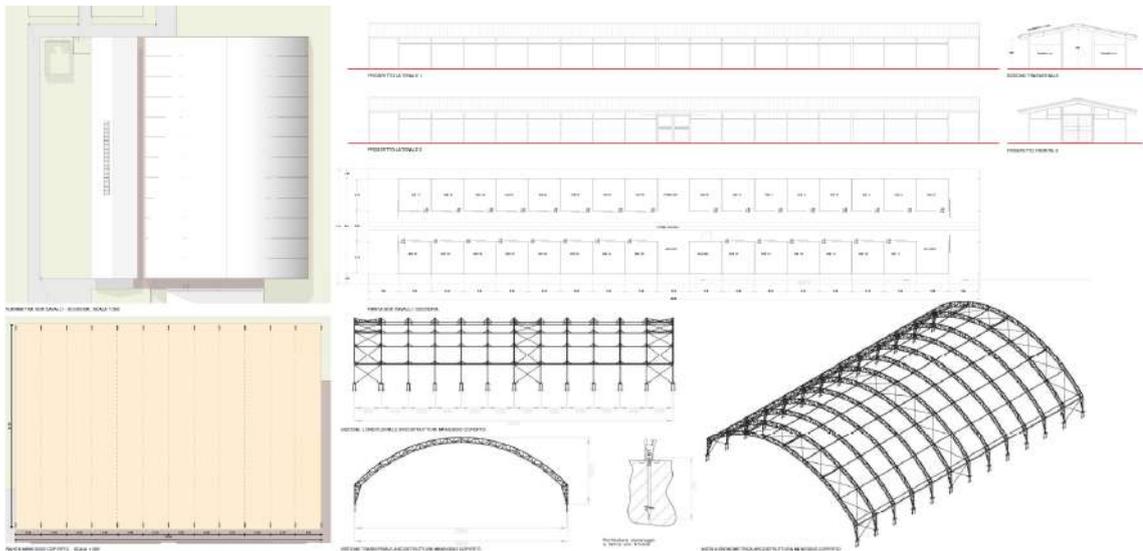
Piante, prospetti e sezioni di box cavalli, scuderia, maneggio coperto
